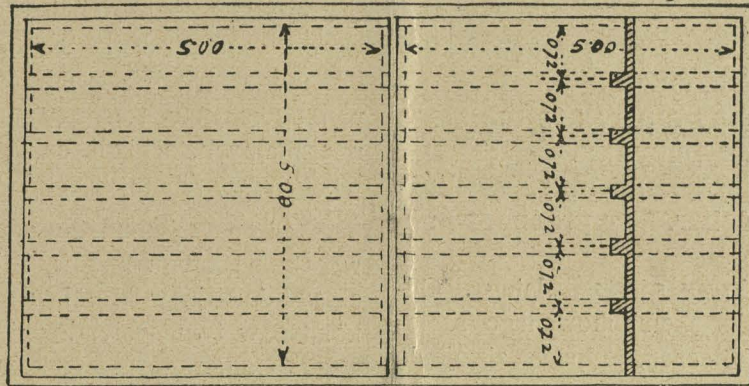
Ułożenie brusów na stropie i przygotowanie do betonowania płyty.
